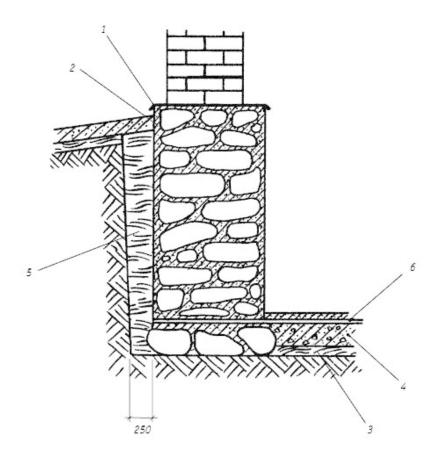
Гидроизоляция фундамента для печи: 1— прокладки из рубероида; 2— битум или цементная штукатурка; 3— цементный пол; 4— нижний слой бетона; 5— утрамбованная глина; 6— гидроизоляция
